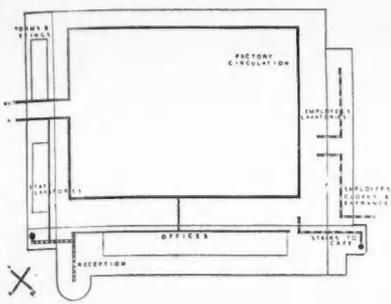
SCHÉMA DU PLAN D'ENSEMBLE
